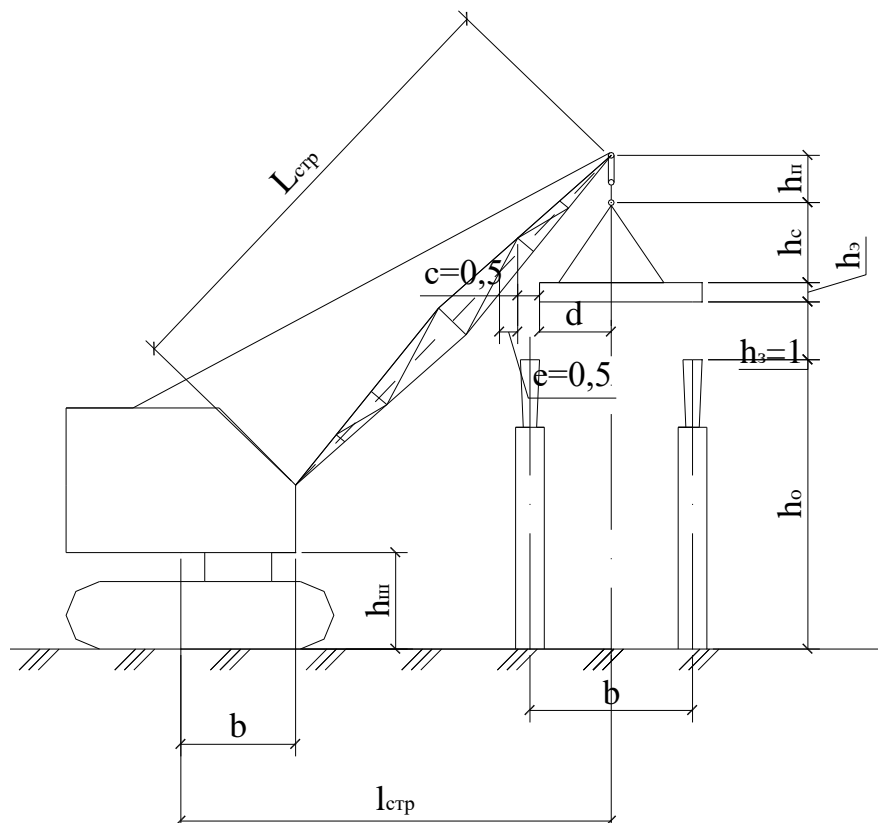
Схема определения монтажного вылета стрелы для плит покрытия
